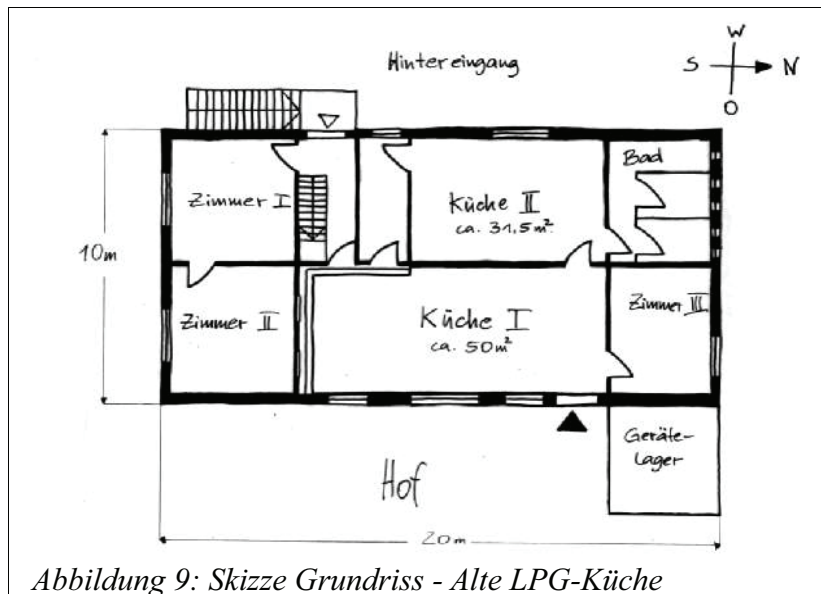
Skizze Grundriss - Alte LPG-Küche
